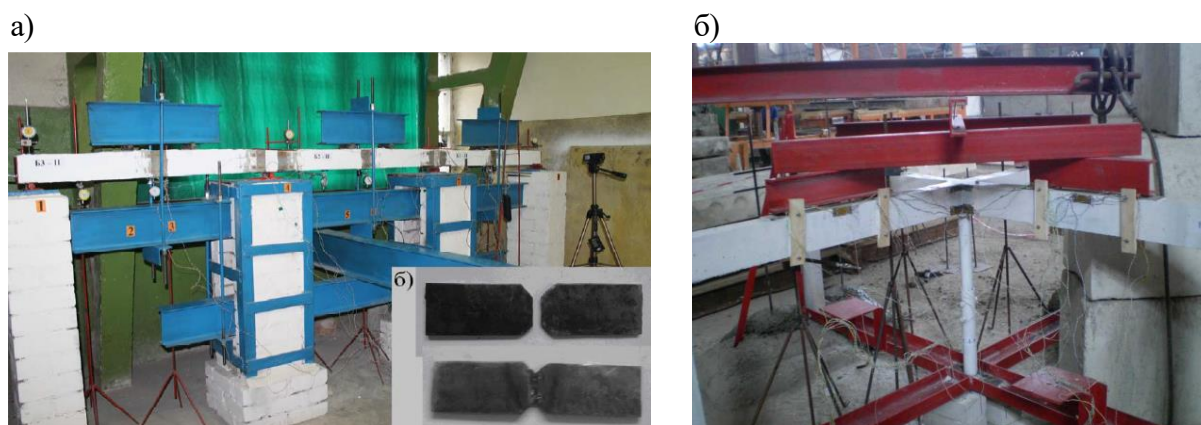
Общий вид испытаний неразрезных железобетонных балок (а); опытного фрагмента пространственной конструктивной системы в виде перекрёстных рам (б)
